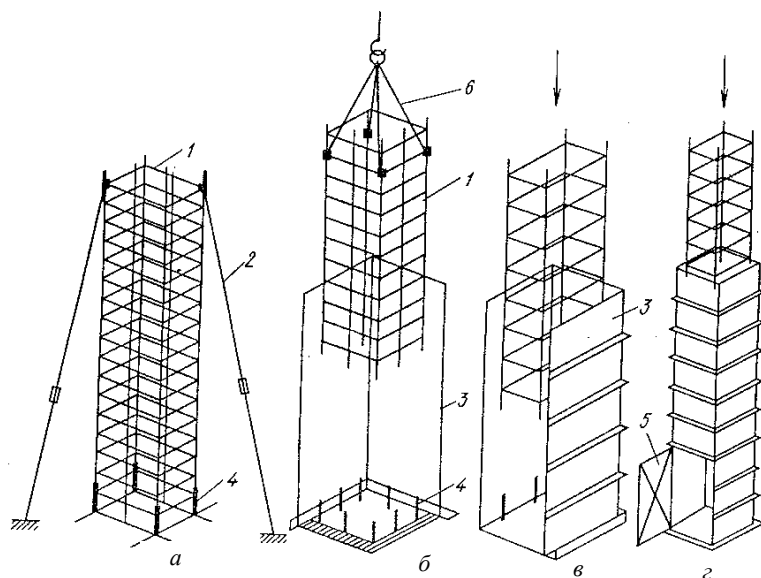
Технологічна схема монтажу арматурних каркасів колон: *а* – установка каркаса в проектное положение с вивіркою розкосами; *б* – те ж у опалубку з двох щитів; *в* – те ж у опалубку з трьох щитів; *г* – при повністю змонтованій опалубці; 1 – арматурний каркас; 2 – розкоси для вивірки й тимчасового кріплення; 3 – щити опалубки; 4 – випуски арматури; 5 – знімний щит для влаштування стиків арматури; 6 – строповочний пристрій
